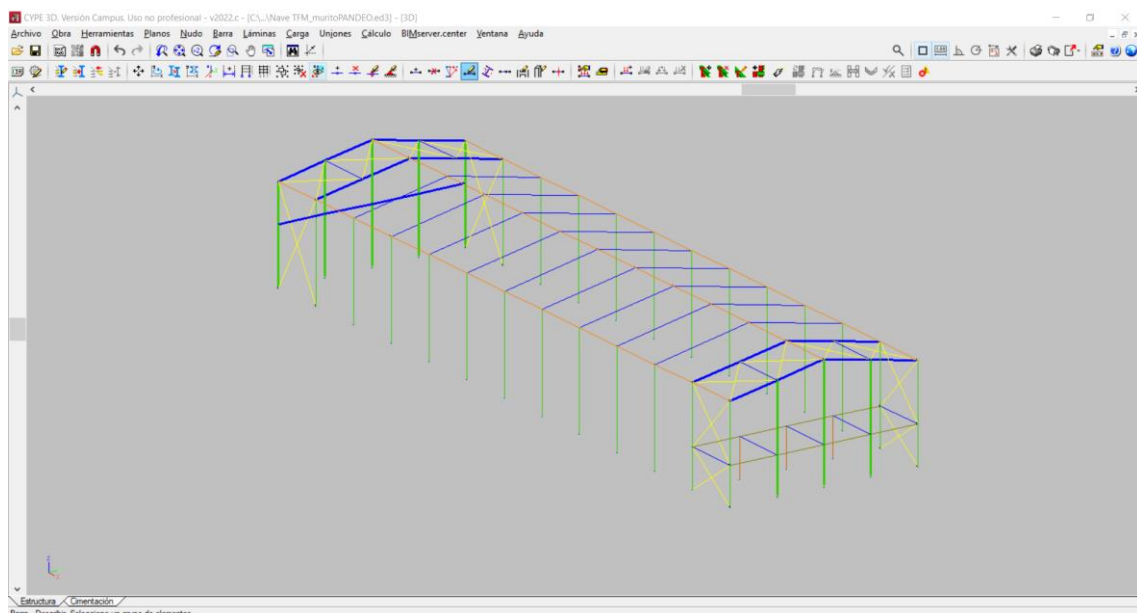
14 Barras de grupo 3 – Vigas de atado indicados en naranja
